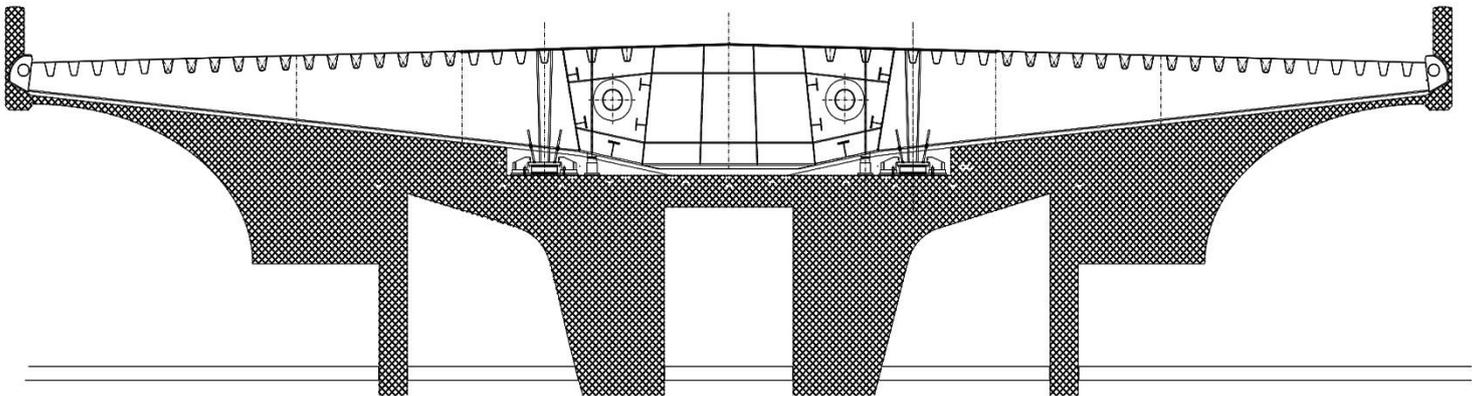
Sección tipo del tablero en conexión con el estribo Sur
